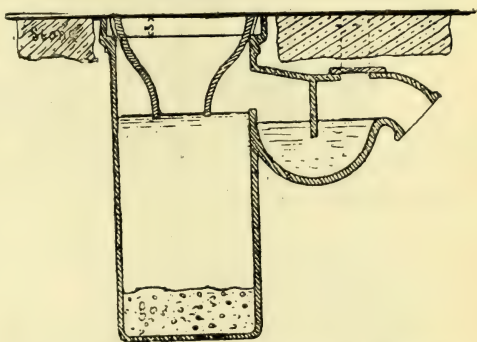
Bouche d'égout inodore, système Newton. (Imbeaux.)
